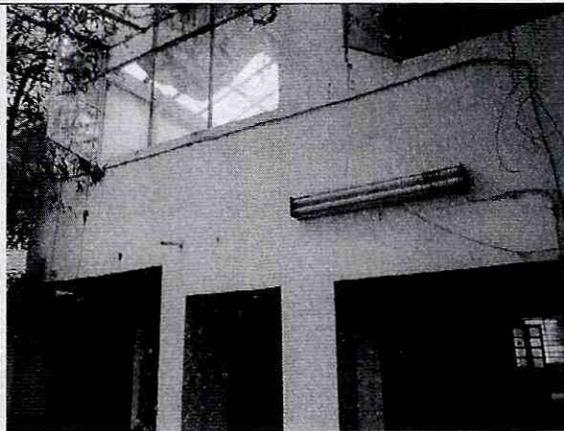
Muros en patio posterior, daño leve, fisuras.
